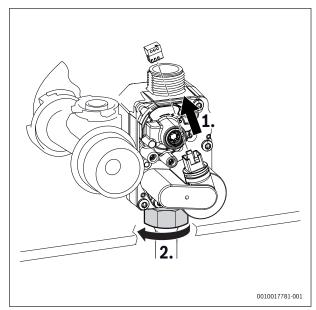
Retirer le connecteur et desserrer l'écrou-raccord
